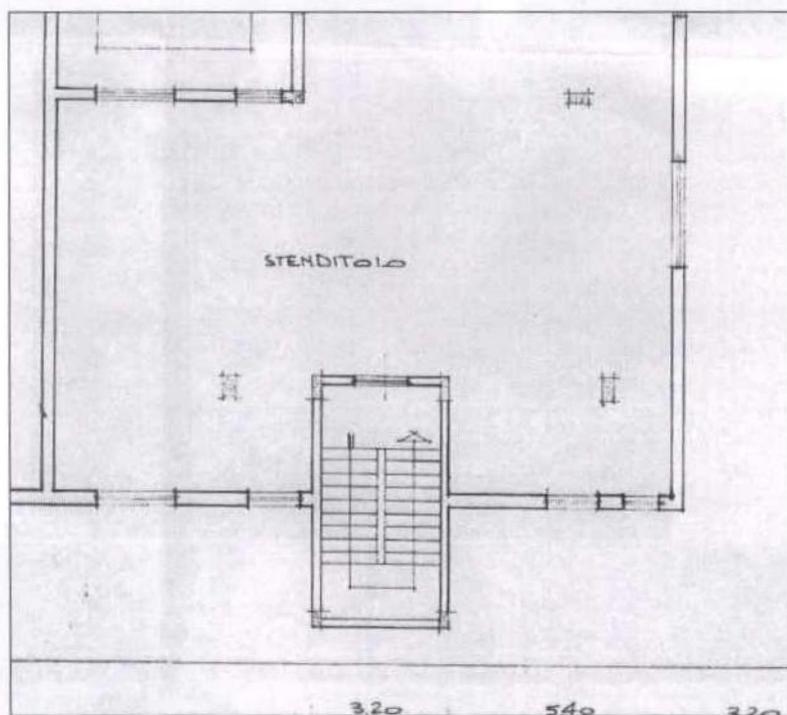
Planimetria di progetto del secondo piano del fabbricato ubicato in via Irpinia n° 6/B.
